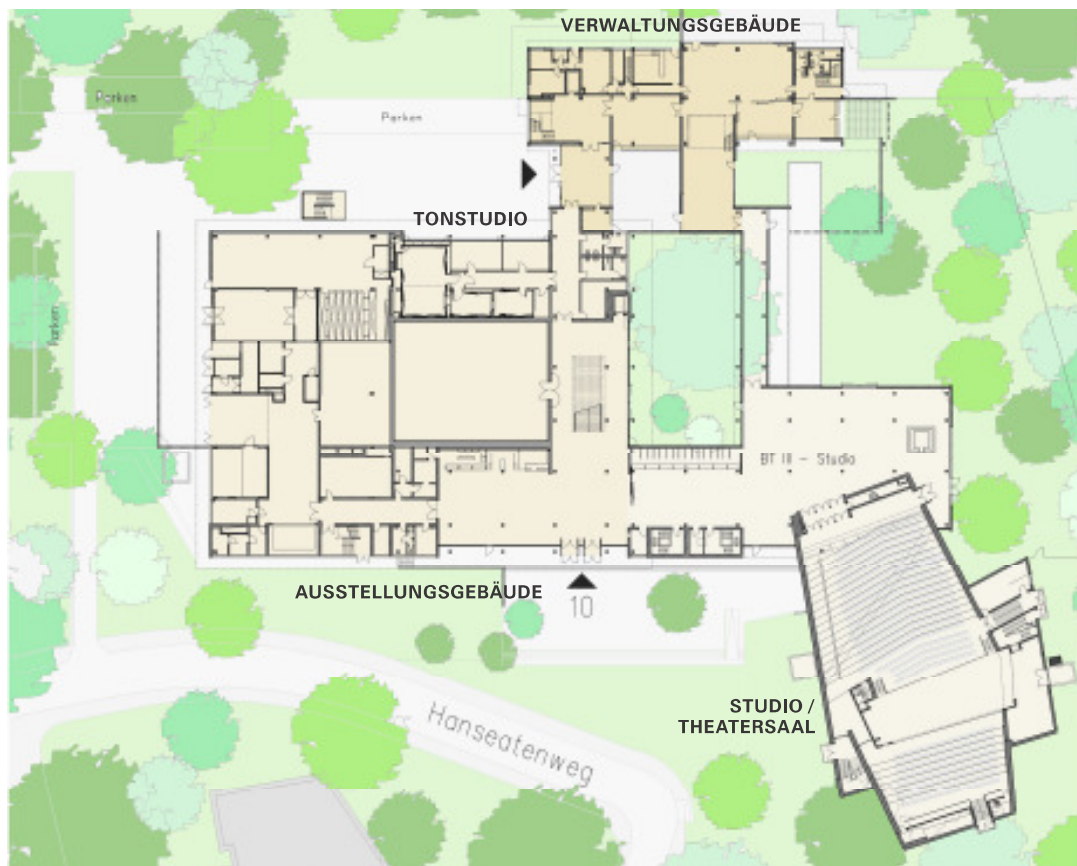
Grundriss der AdK, Standort Hansaviertel, Erdgeschoss, nach der Sanierung, 2012, Brenne Architekten.
